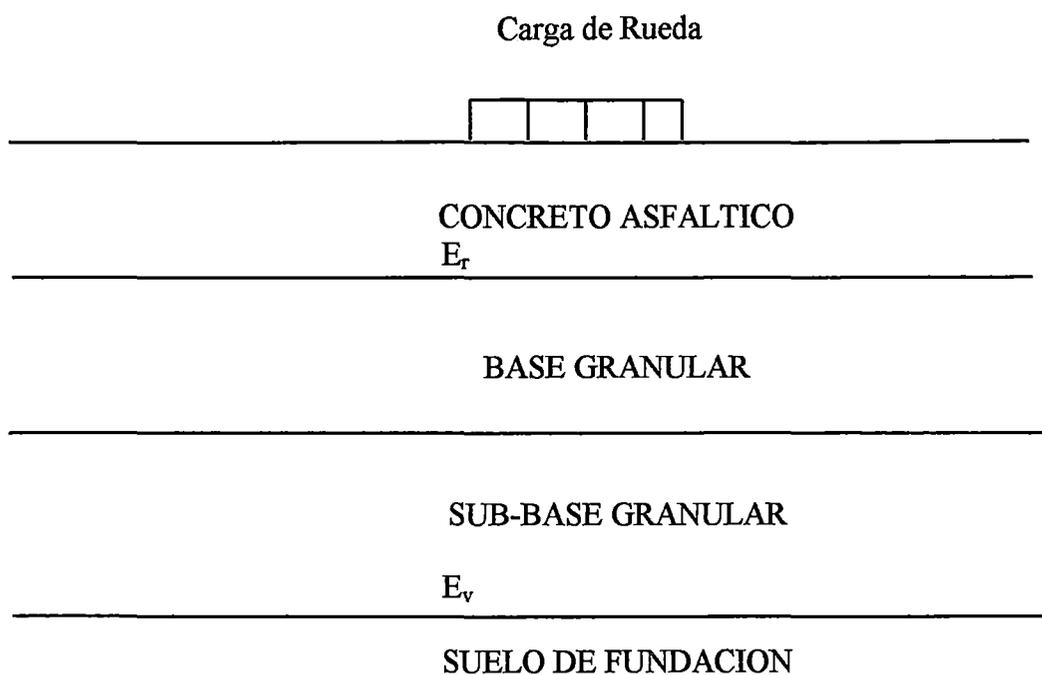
Pavimento asfáltico sobre base y subbase granular.
